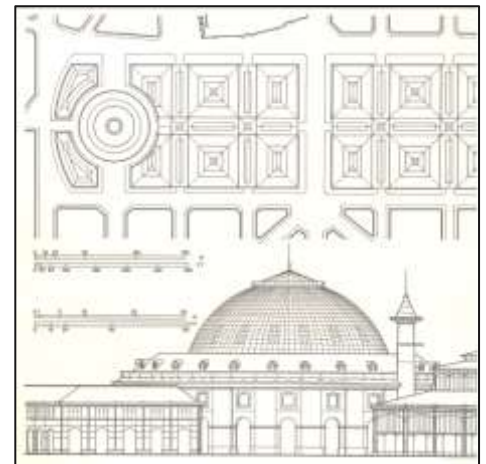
Plan et façade d'une partie de Crystal Palace
